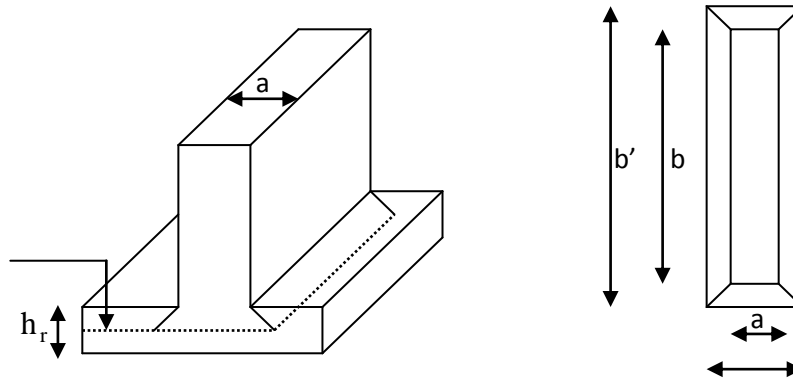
Périmètre utile des voiles et des poteaux.
